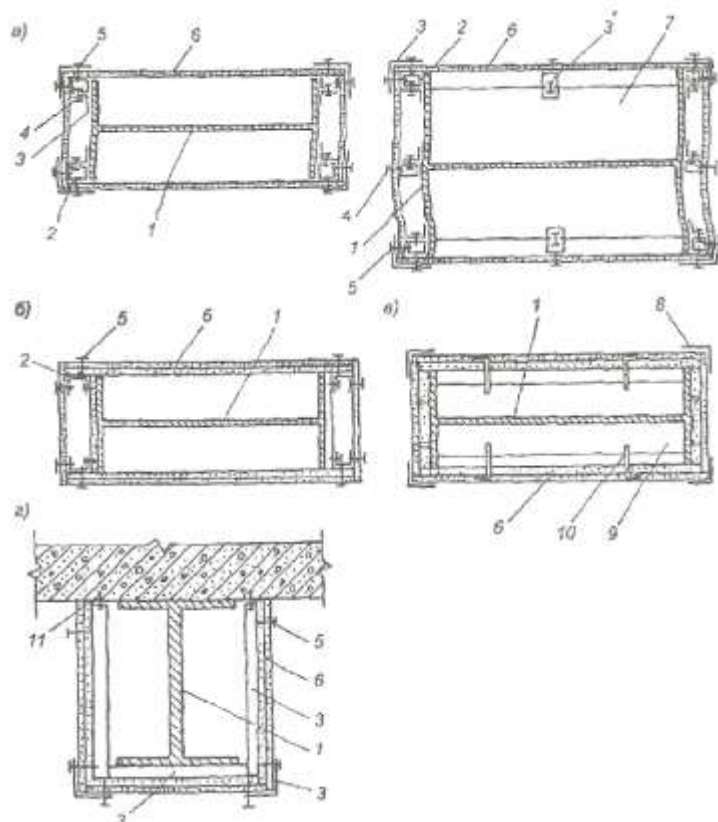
Поперечные сечения стальных колонн и балок с конструктивной огнезащитой гипсокартонными листами:
